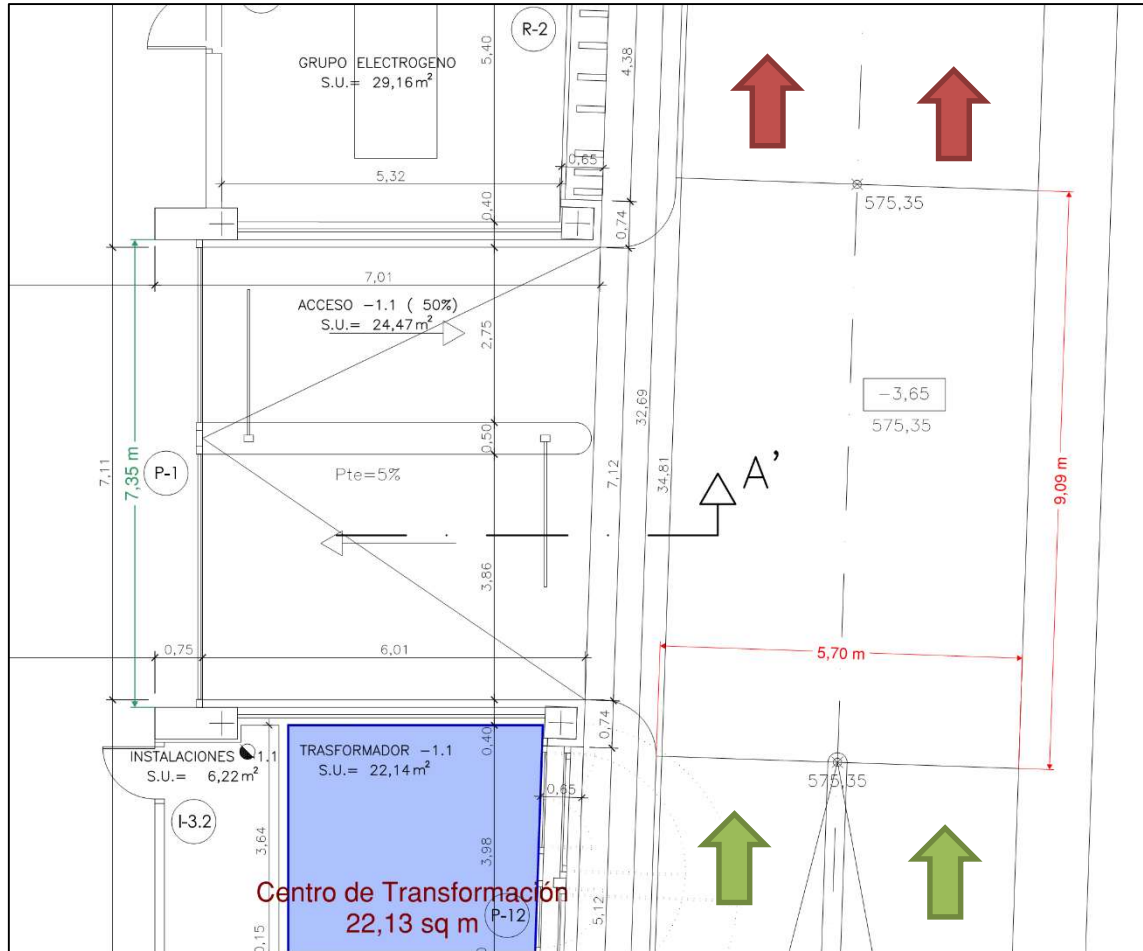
Meseta de desembarque para acceder al garaje en planta baja. Como puede observarse hay 9,09 m que se ajusta al requisito de 4,5 m. a cada lado de las rampas.
